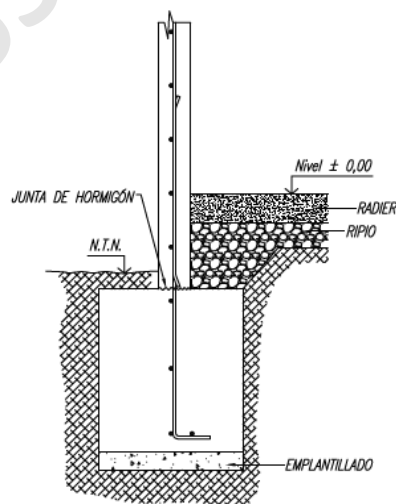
Ubicación de acero de refuerzo para muro de hormigón con malla Central. (Fuente: Manual de detallamiento casas 1 y 2 pisos, Hormigón armado, ICH)
